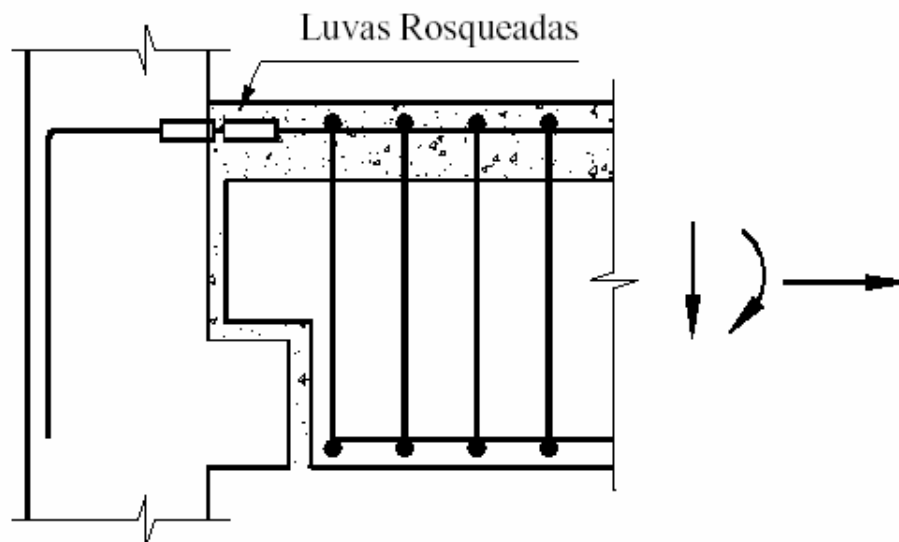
Mecanismo estrutural para a ligação viga-pilar com consolo de concreto.
